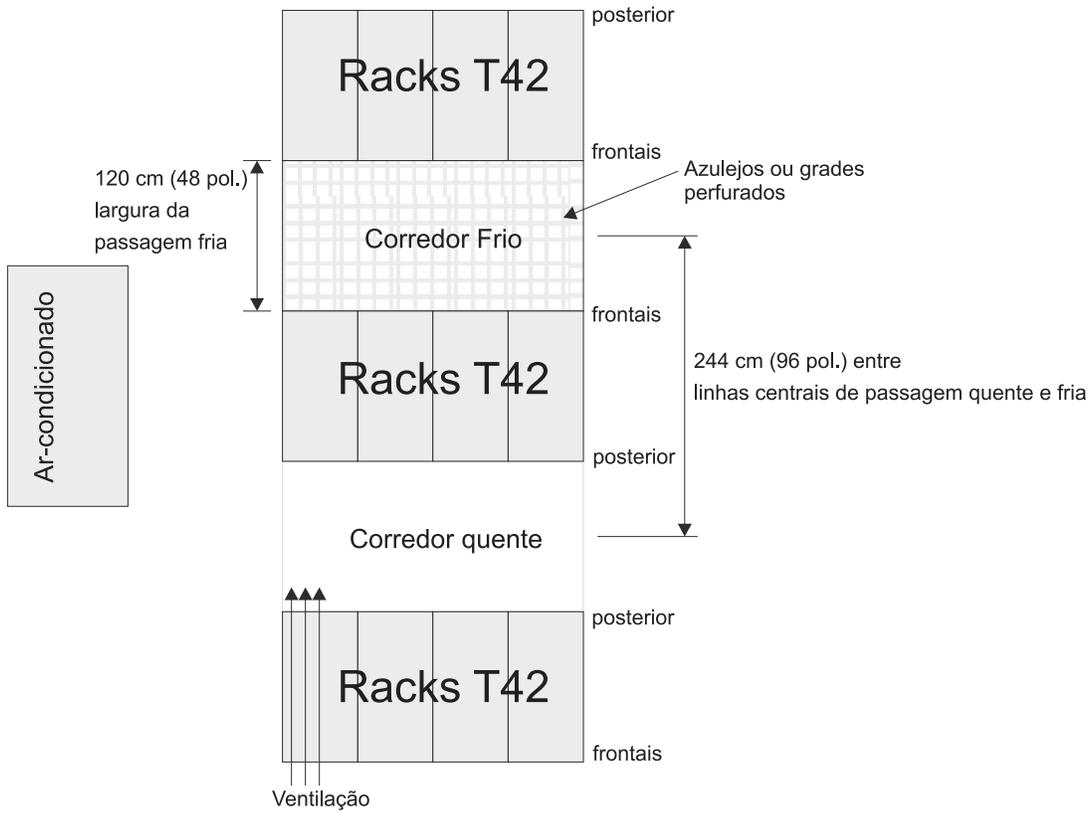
Exemplo de Configuração de Rack com Passagem Fria/Passagem Quente
